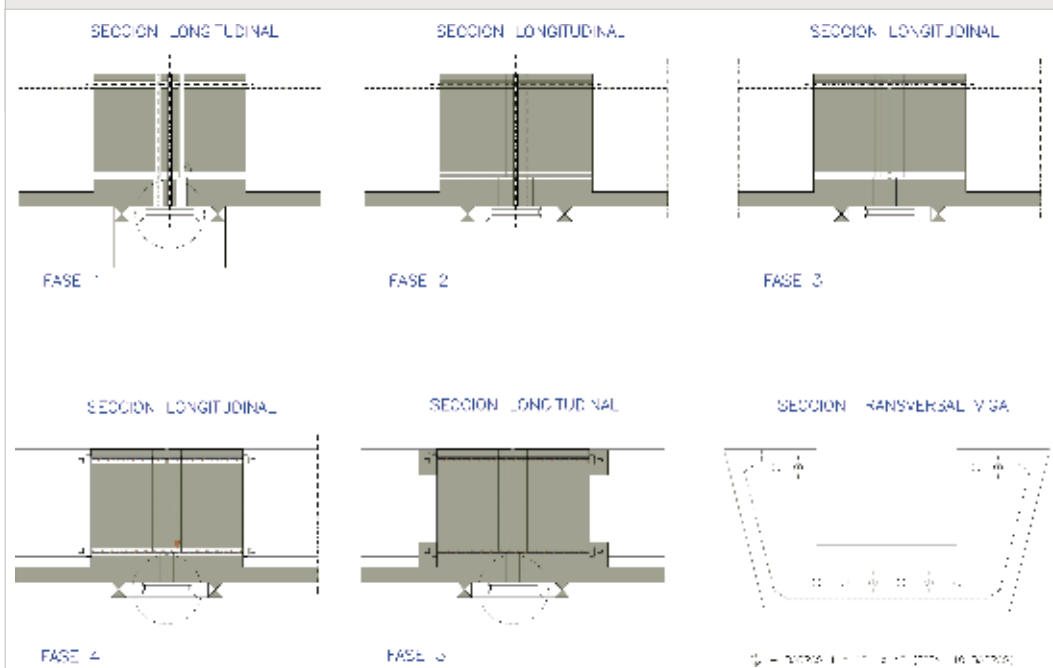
Detalles de unión de las vigas prefabricadas para garantizar la continuidad estructural y la resistencia de fuerzas horizontales del tablero
